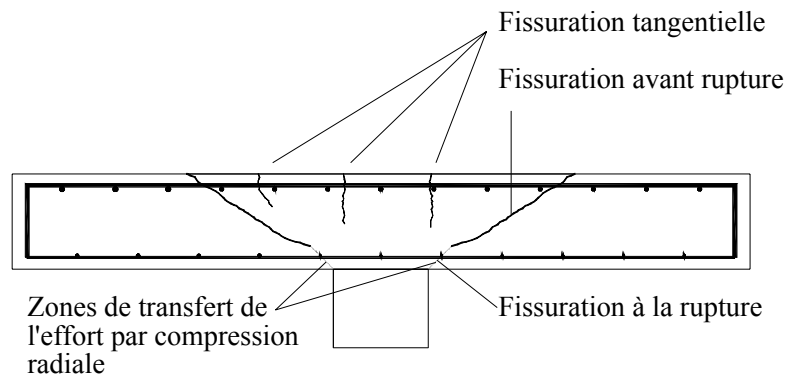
Fissuration lors d'une rupture par poinçonnement
